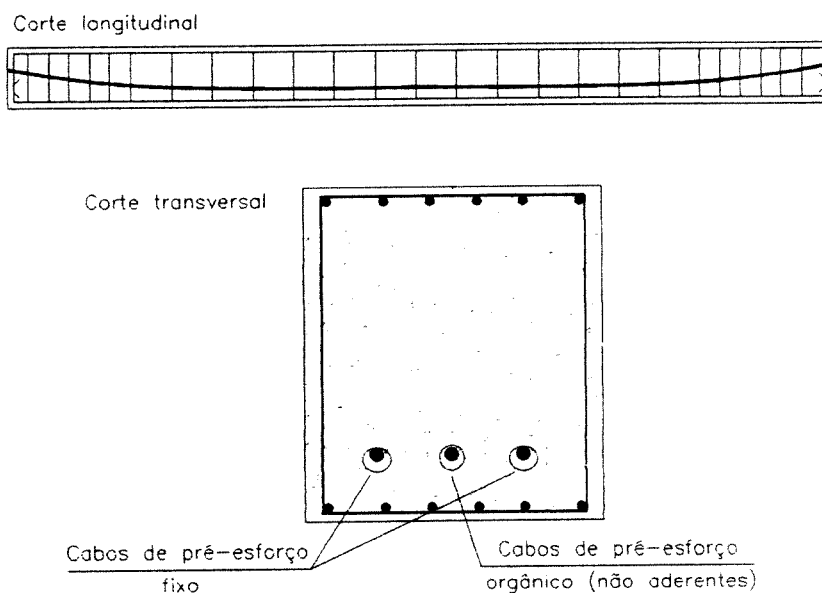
Cortes longitudinal e transversal de uma *estrutura base* de betão armado pré-esforçado
